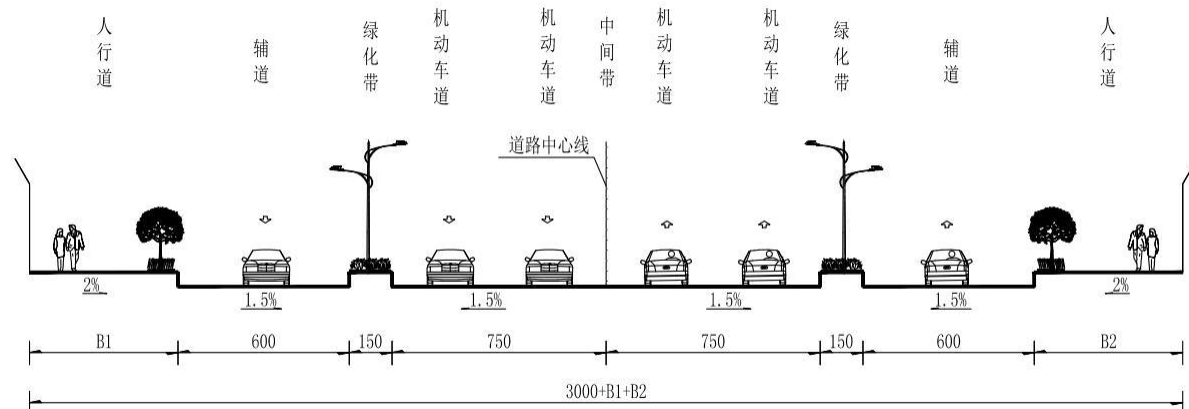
道路标准横断面图（塘汛街东段、西段）
